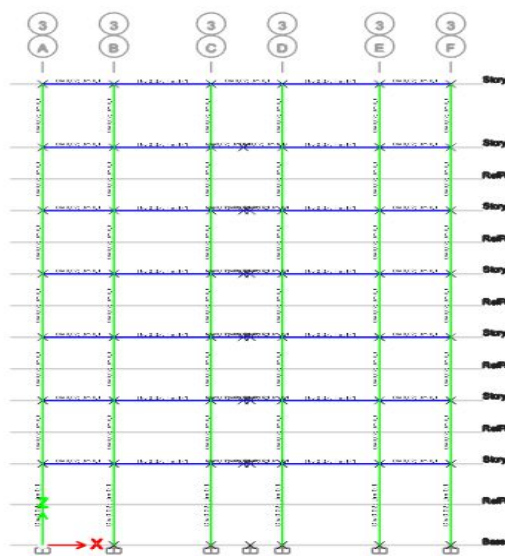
Les rotules plastiques au niveau des poteaux et des poutres.
